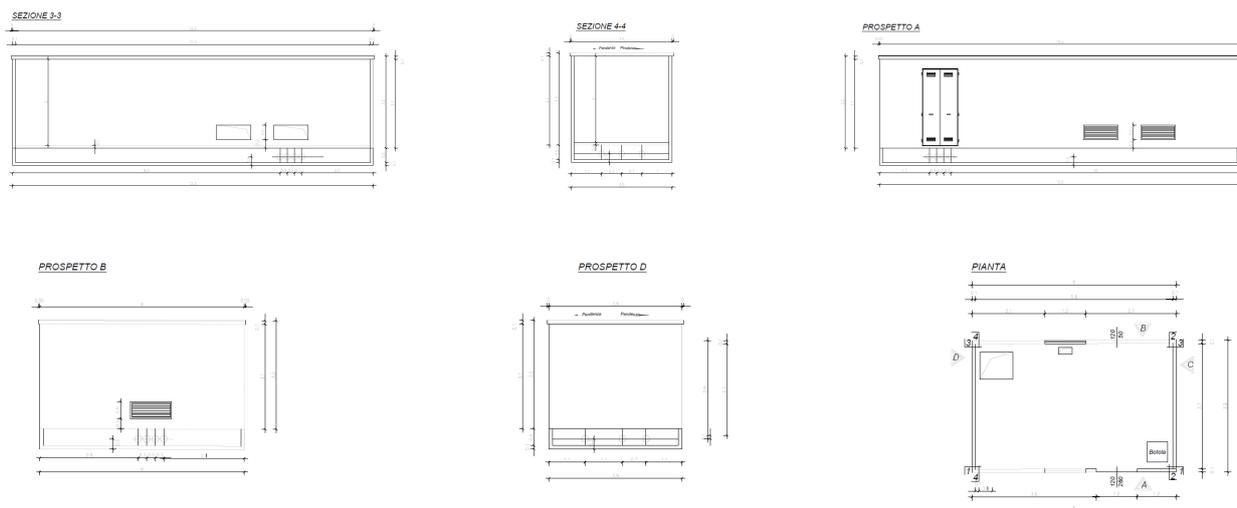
sezione e prospetto delle cabine di campo; prospetto e pianta delle cabine di sottocampo.
